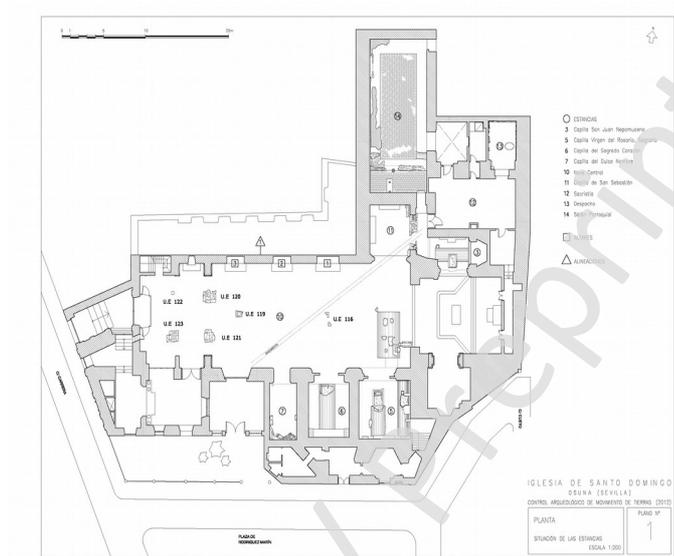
Plano con la situación de los pilares objeto de saneamiento
